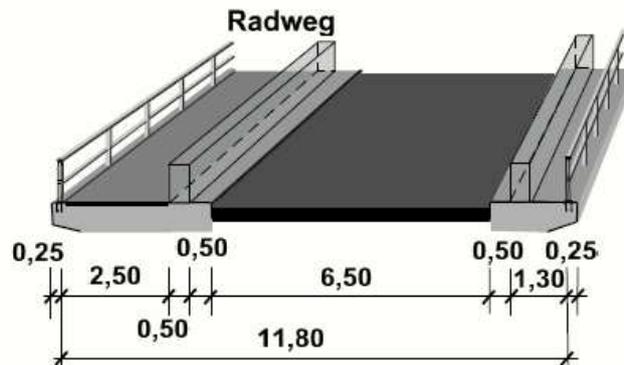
Querschnitt Bauwerk Gerb 04 - Gemeindestraße
